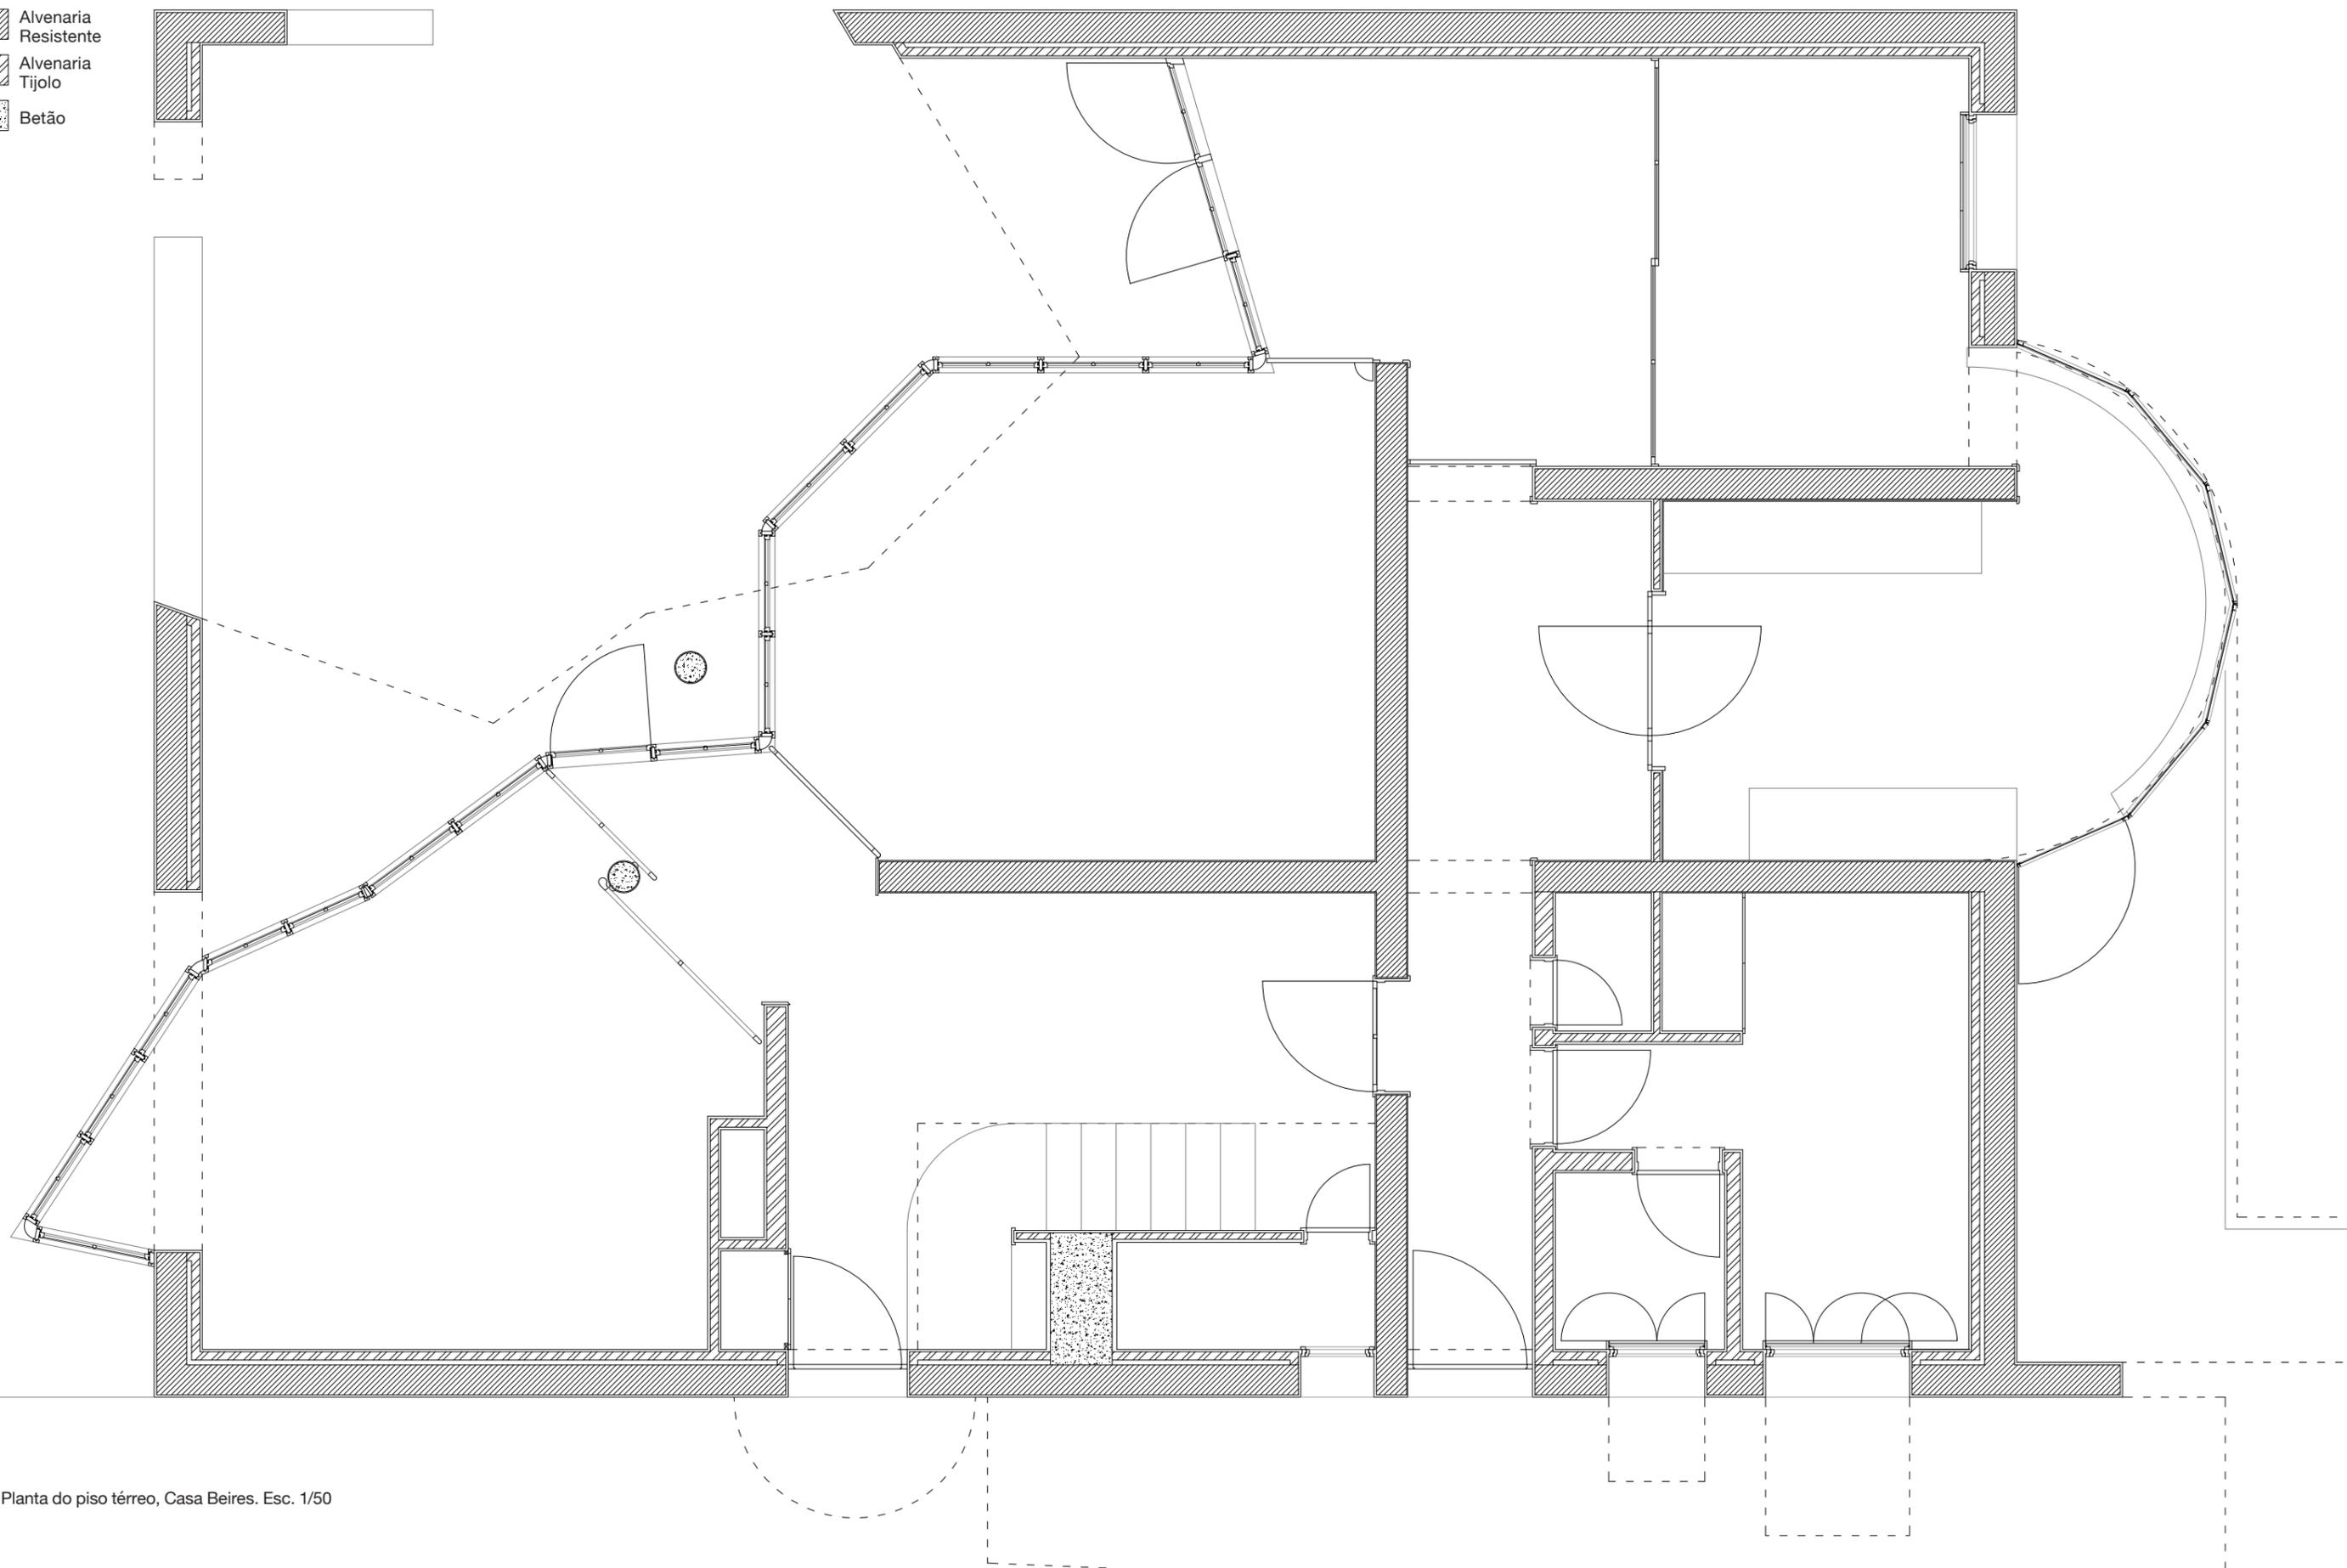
Planta do piso térreo, Casa Beires. Esc. 1/50
